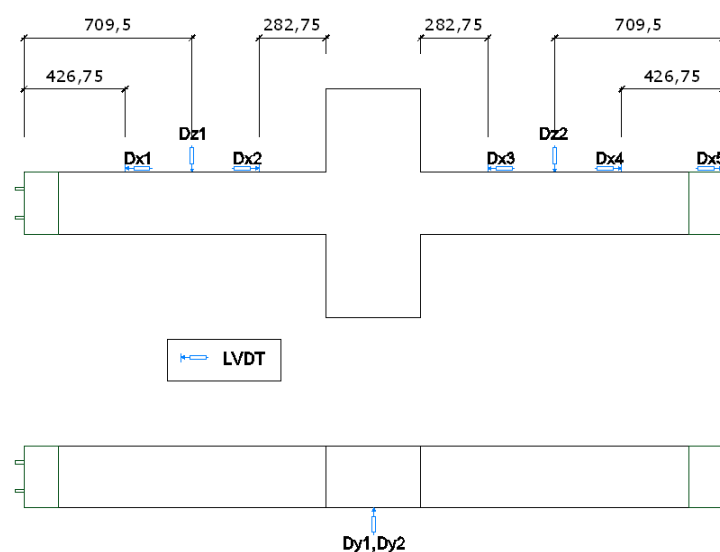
Instrumentación de las probetas testigo (cotas en mm)
